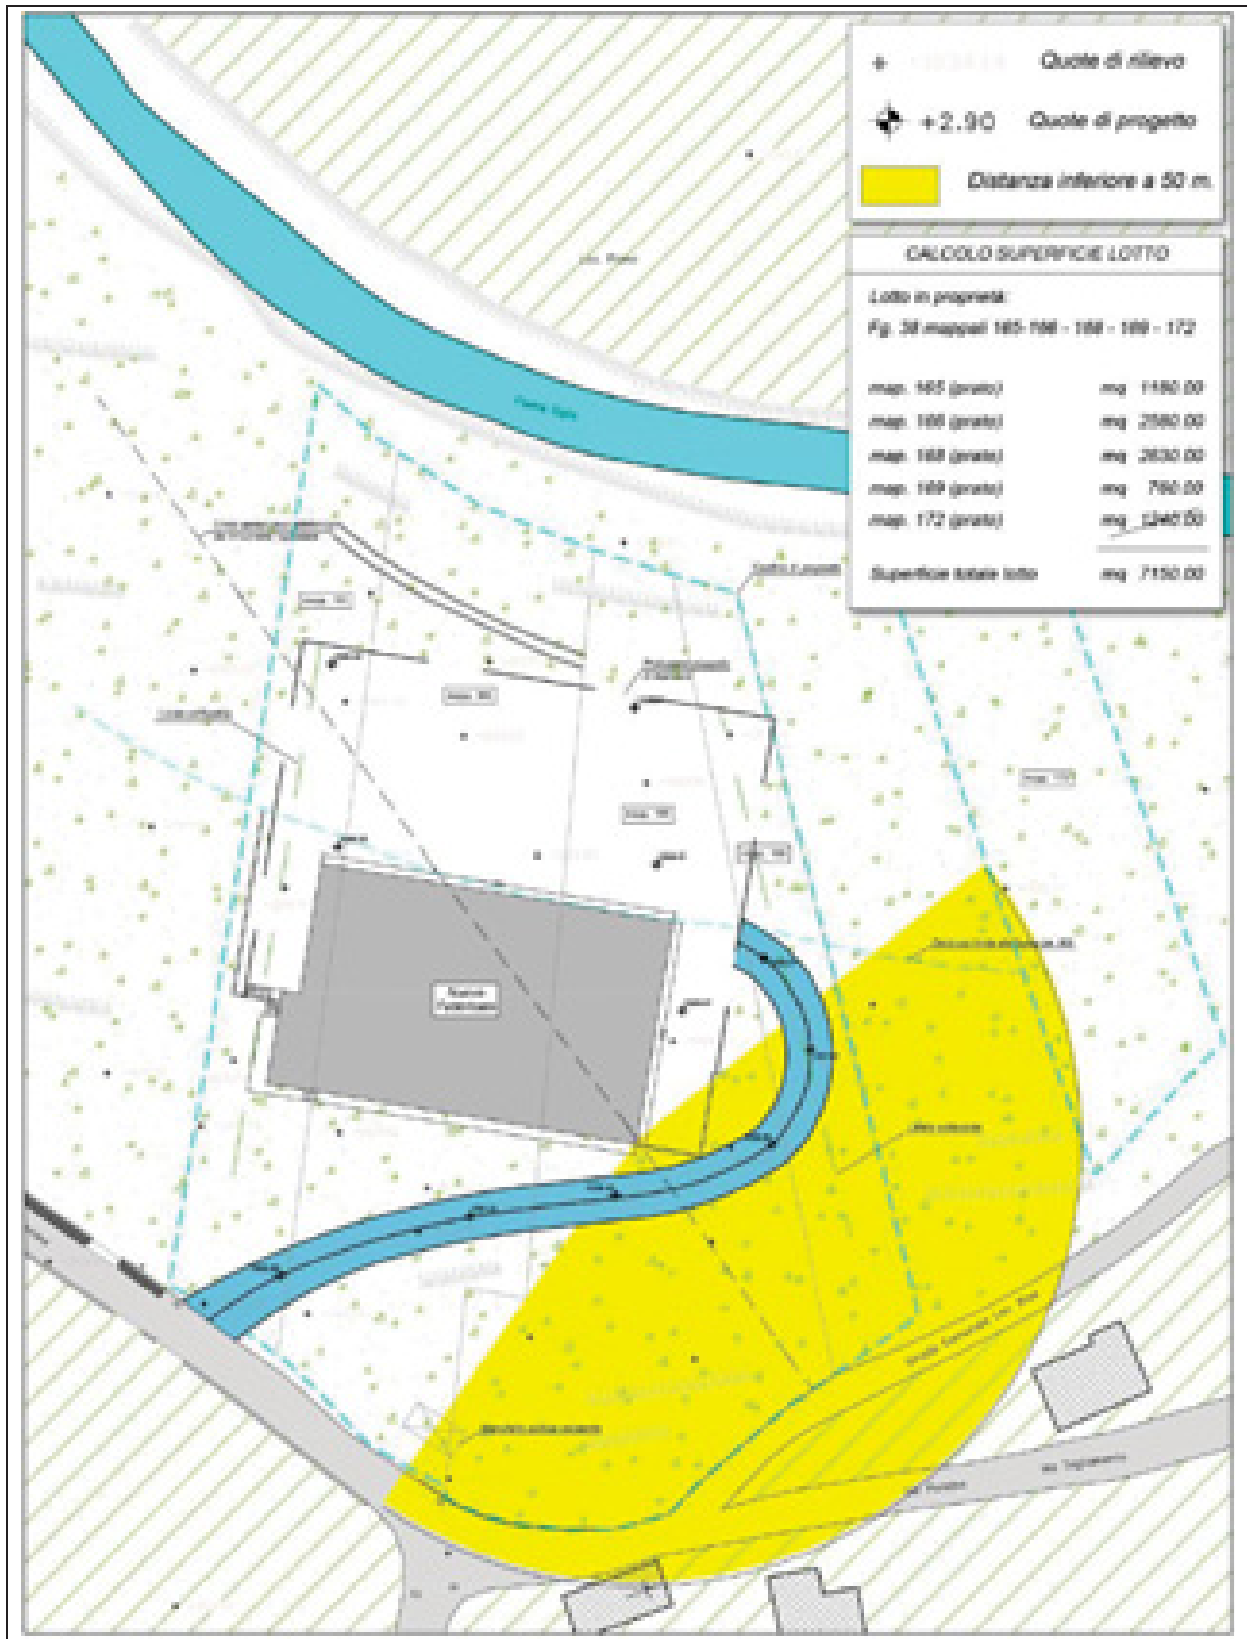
SUAP, planimetria generale (fuori scala).
